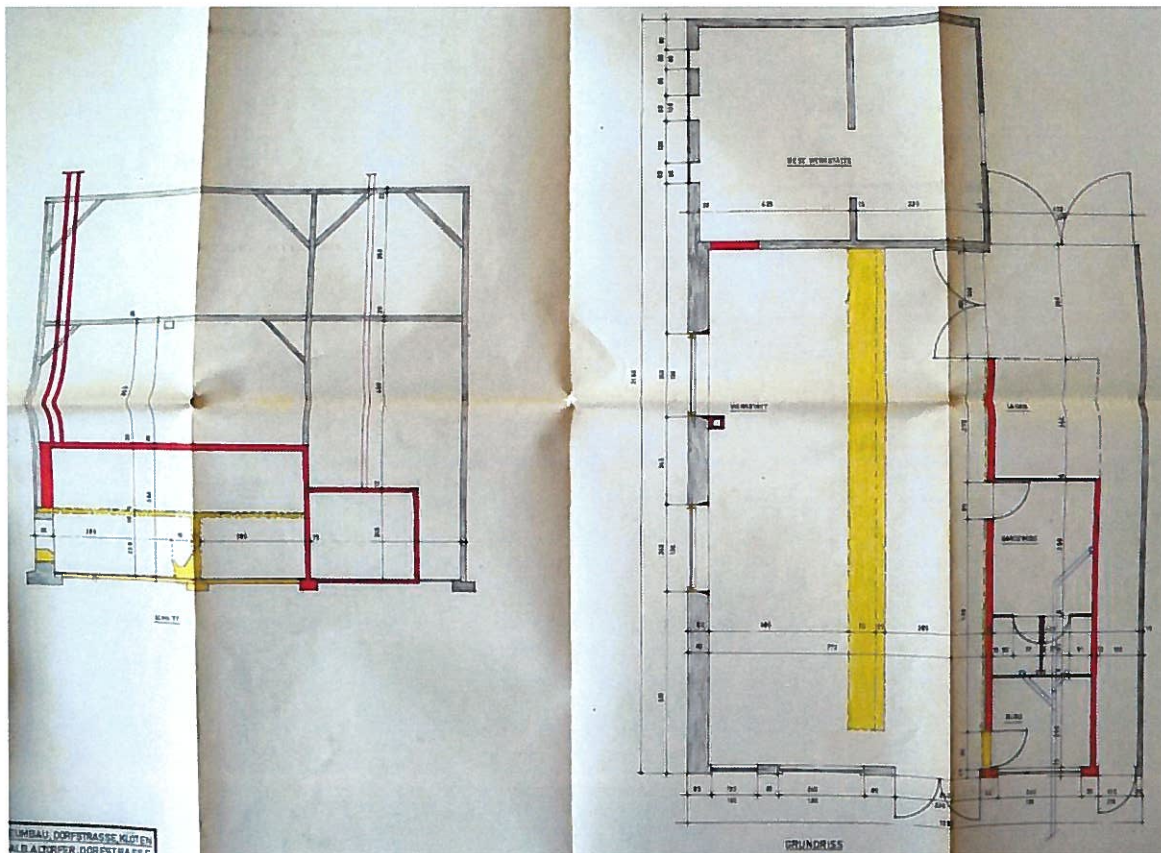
Einbau einer Werkstätte in die Ökonomie. Grundriss Erdgeschoss, Schnitt, 30.11.1965. Bauakten Gemeinde Kloten.
